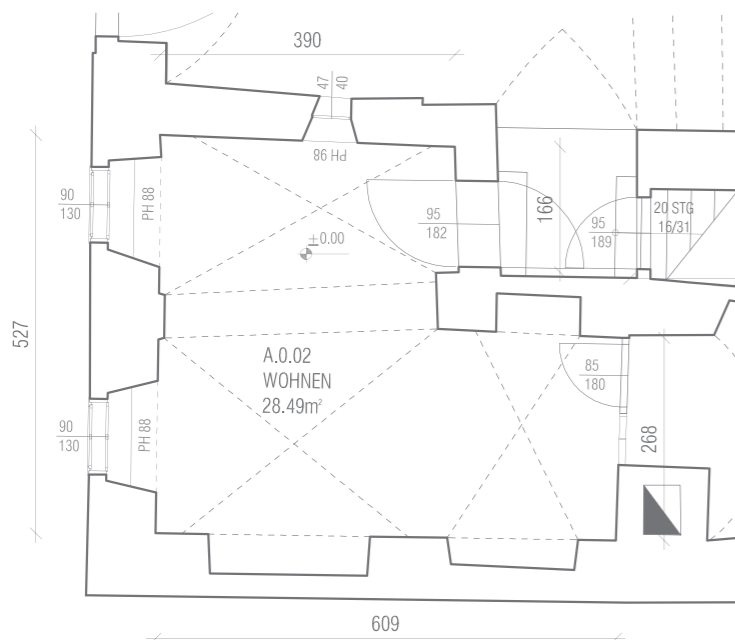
Grundriss Raum A.0.02_1:100
